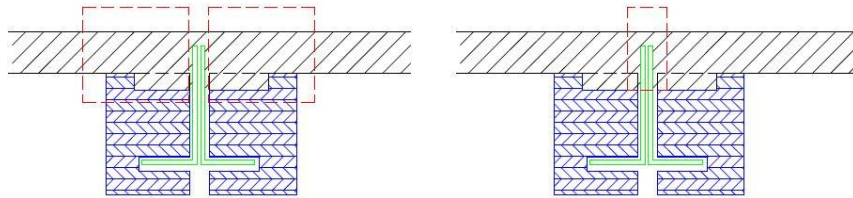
zunächst in Einzelabscherversuchen zu untersuchende Verbindungen, die dann zu einer allgemeinen Lösung zusammengefasst werden; (a) Holz-Beton-Schubverbindung, (b) Stahl-Beton Schubverbindung
